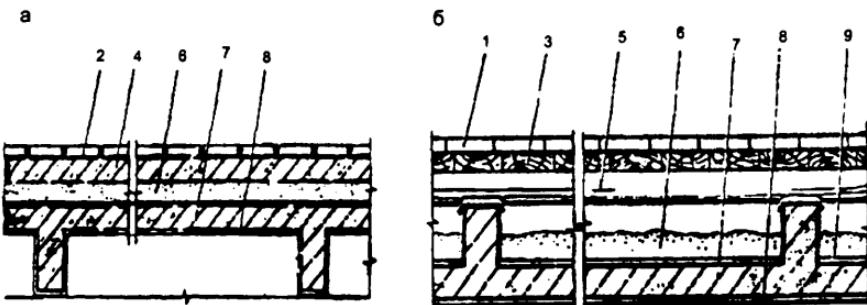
Междуэтажное монолитное железобетонное ребристое перекрытие:
